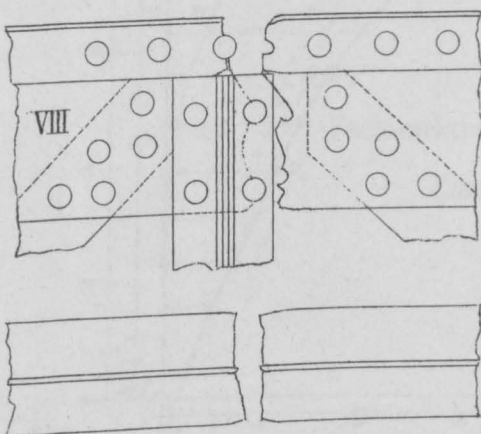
Prager Schweißseisen. Versuch 7.-10.-1889.
